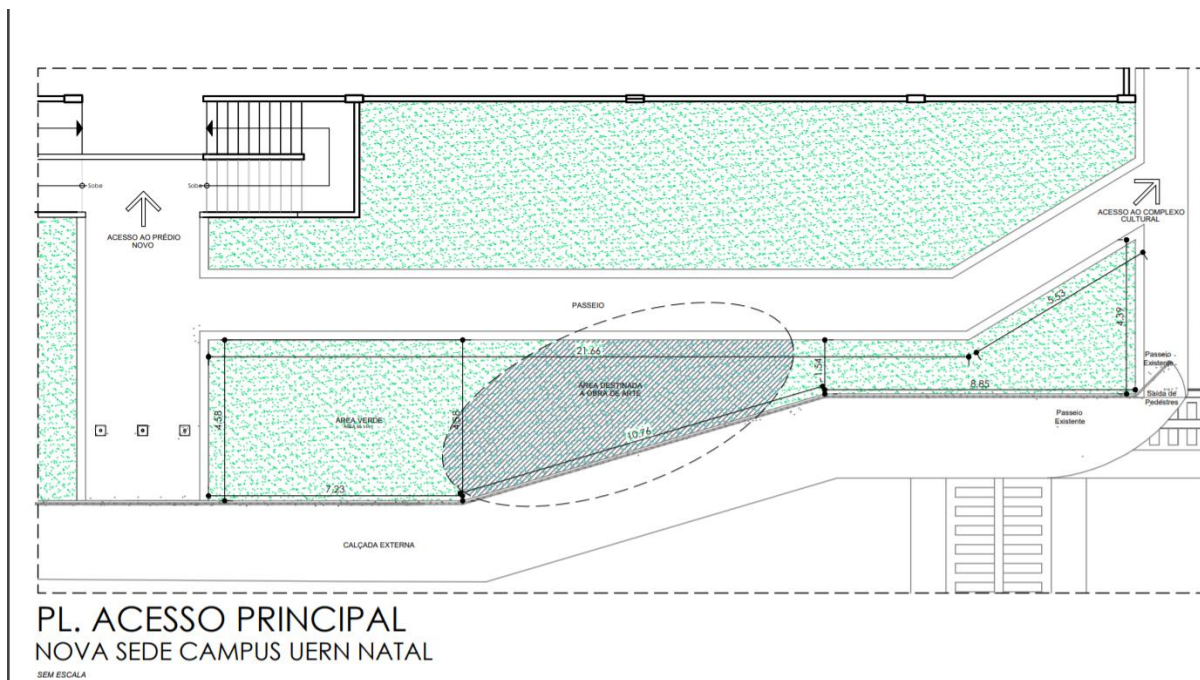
Planta com destaque na área para instalação da obra de arte
